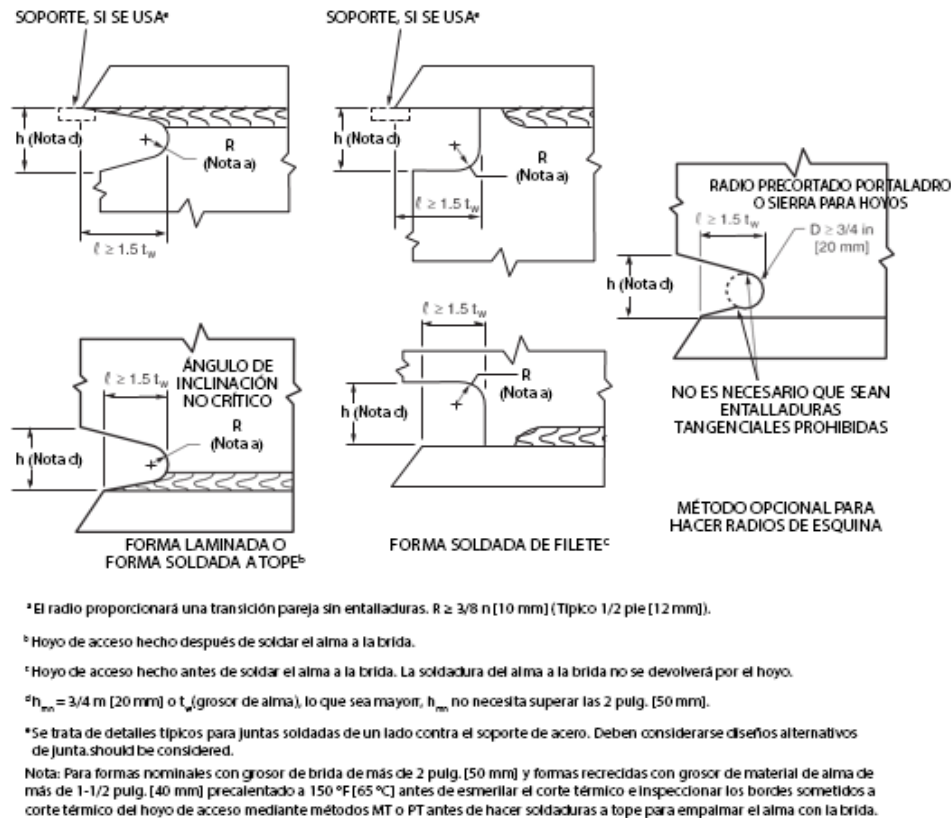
Geometría de hoyo de acceso a la soldadura (ver 5.16.1.2)
